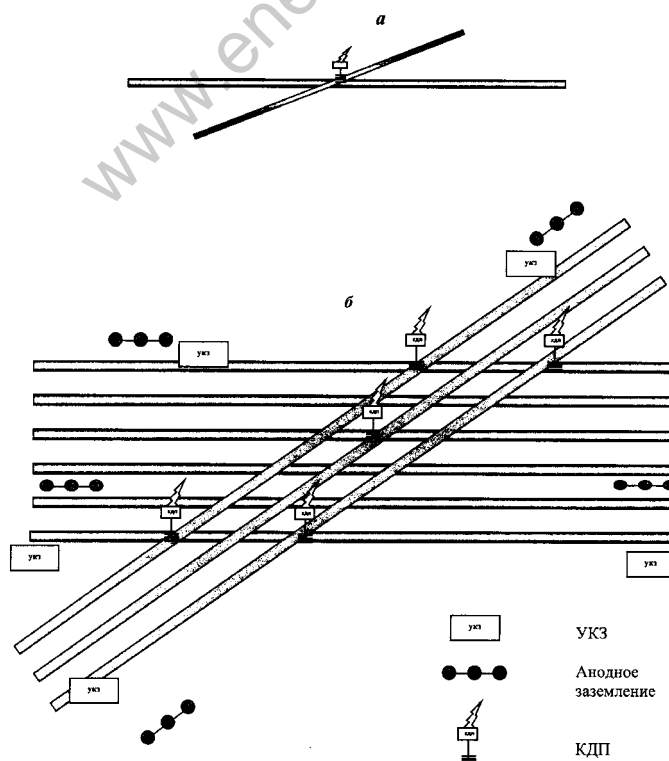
Схема монтажа КДП на пересечениях однопроводных (а) и многопроводных (б) магистральных газопроводов
